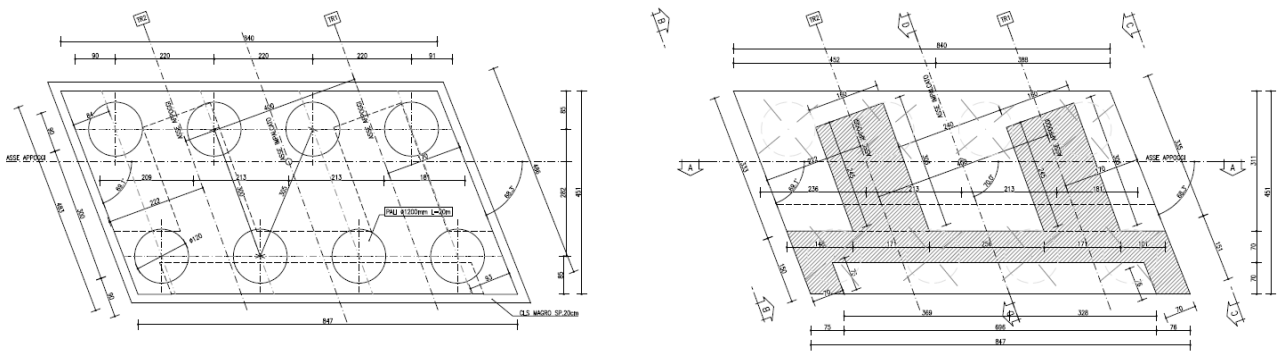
Spalla 2 – carpenteria fondazioni
